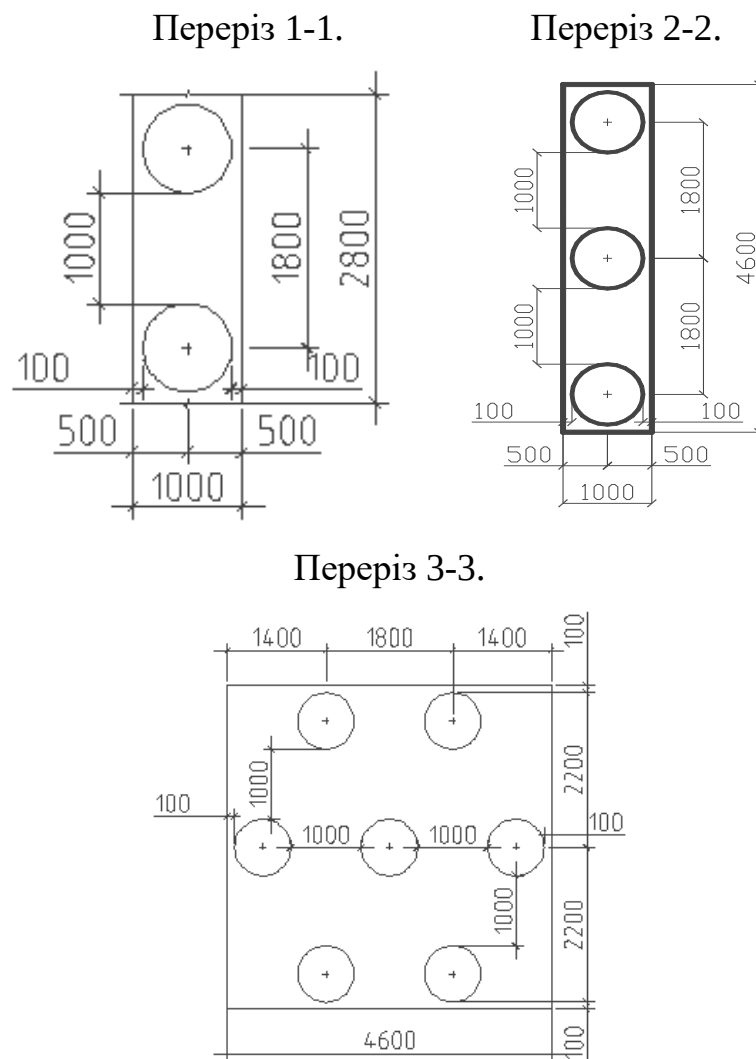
Конструкція ростверку пального фундаменту.
